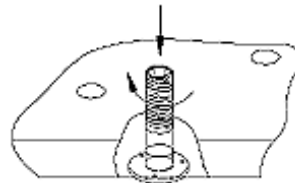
Засвердлюється отвір у бетоні через болти-стійки конструкція на перекриття.
